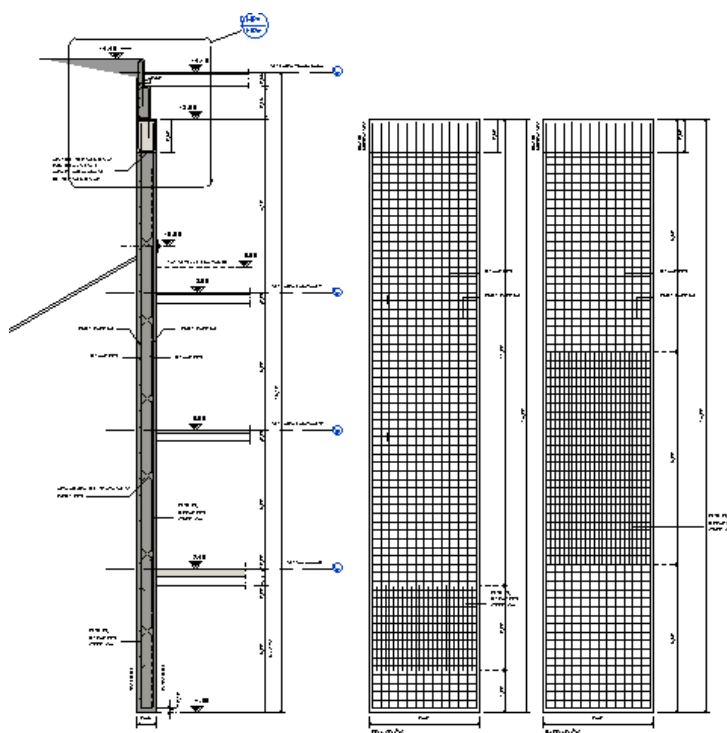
Familia muro pantalla donde el dibujo de la armadura está parametrizado
